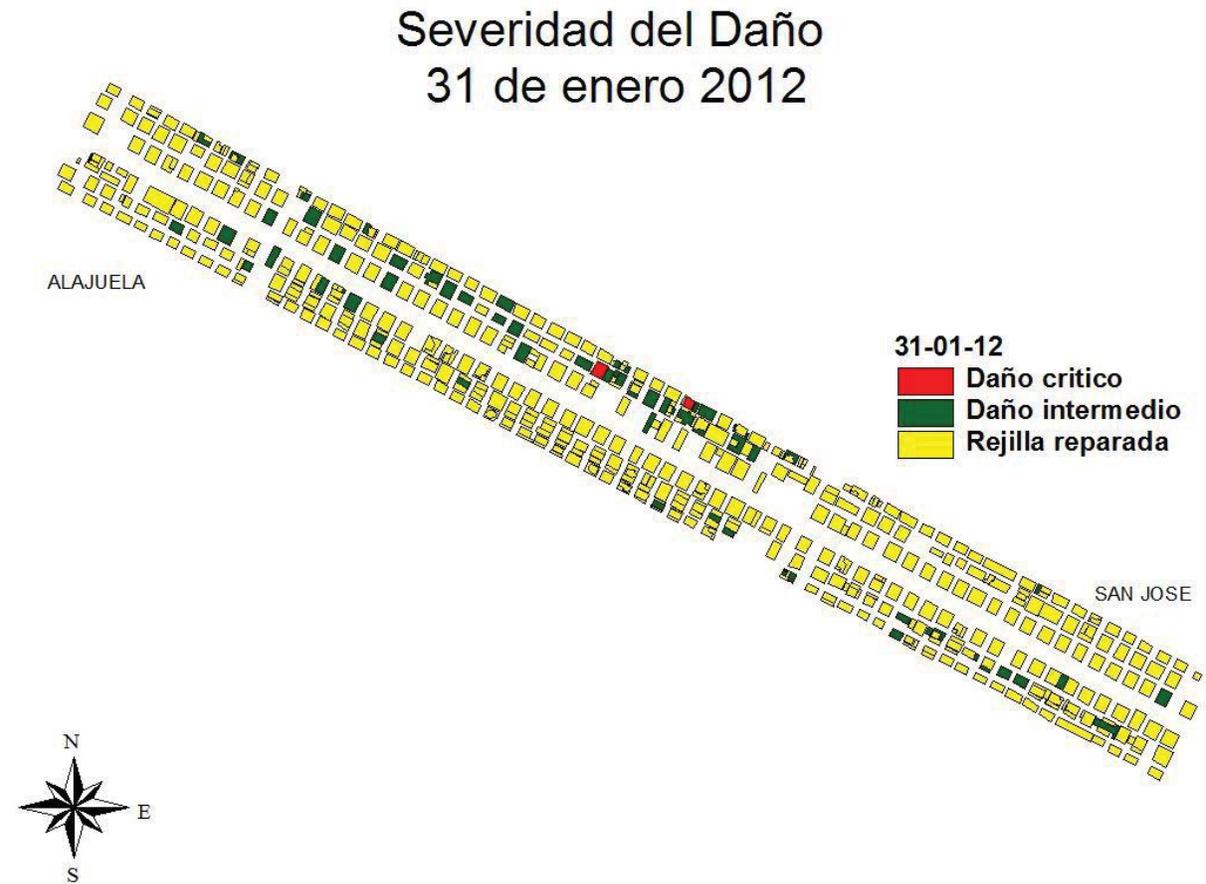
Ubicación de las zonas deterioradas en la losa sobre el puente
